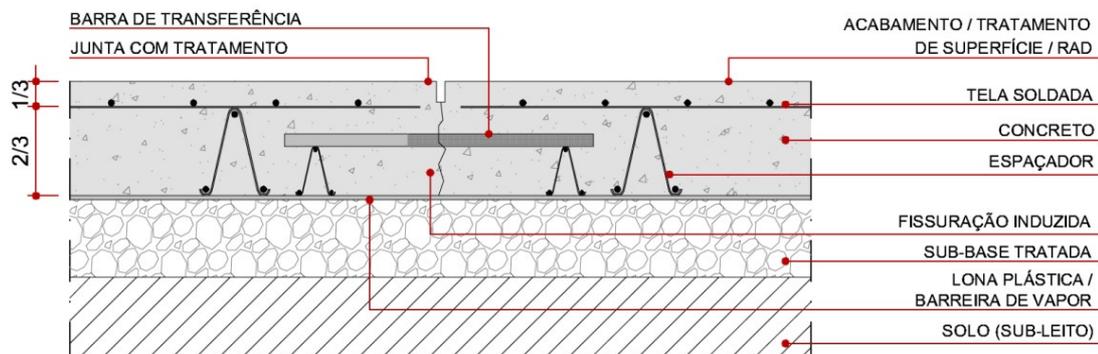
Pavimento de concreto com armadura distribuída descontinuamente
